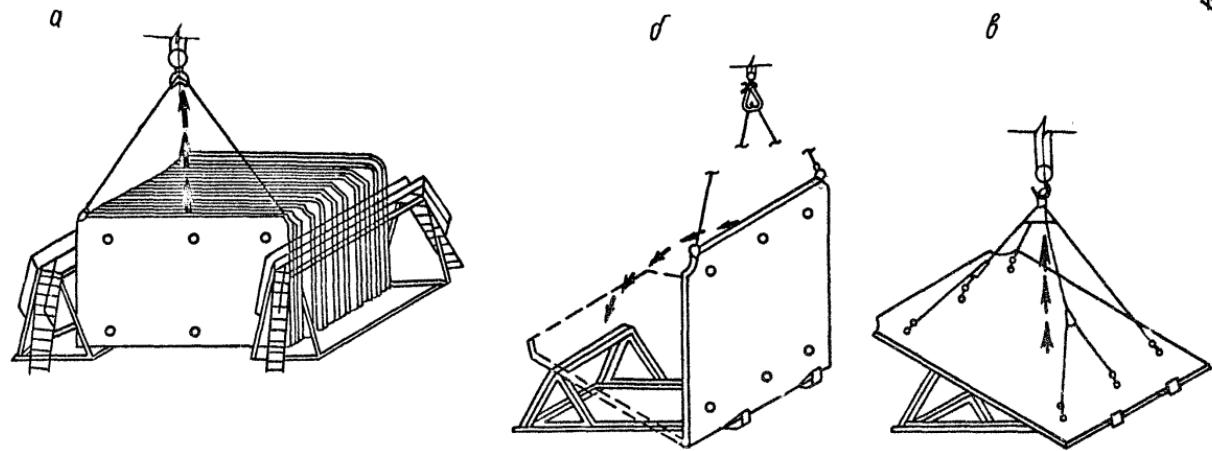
Последовательность перестройки панелей перекрытия: а-подъем панели перекрытия из кассеты; б-кантовение панели перекрытия; в-перестройка
